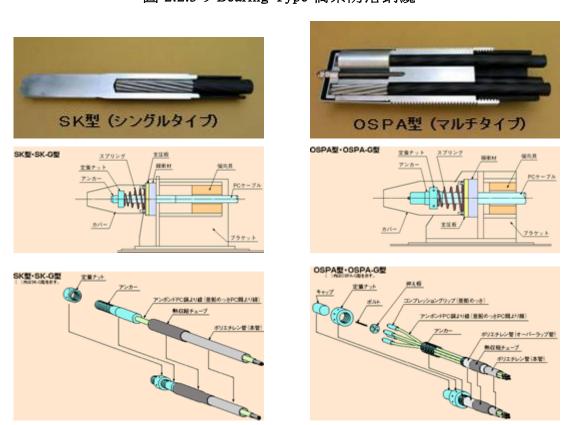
Bearing-Type 橋梁防落鋼纜構造示意圖
